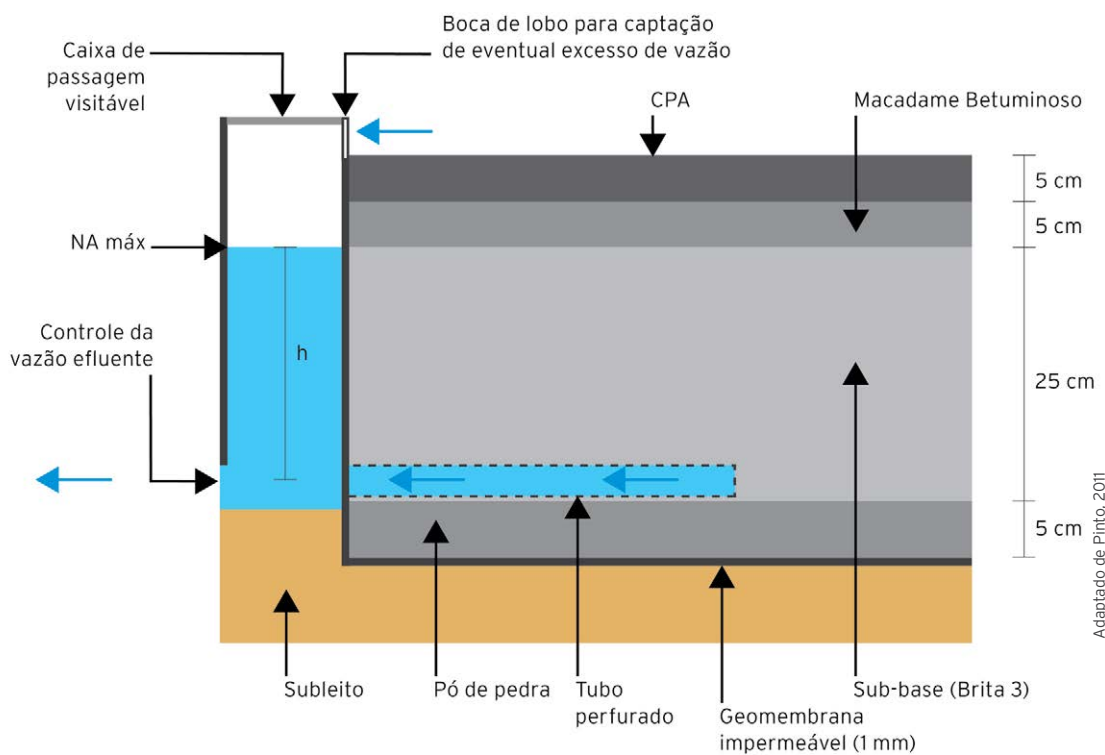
Corte típico de pavimentos permeável para tráfego leve revestido de Concreto Asfáltico Poroso (CPA) sem infiltração no solo.
